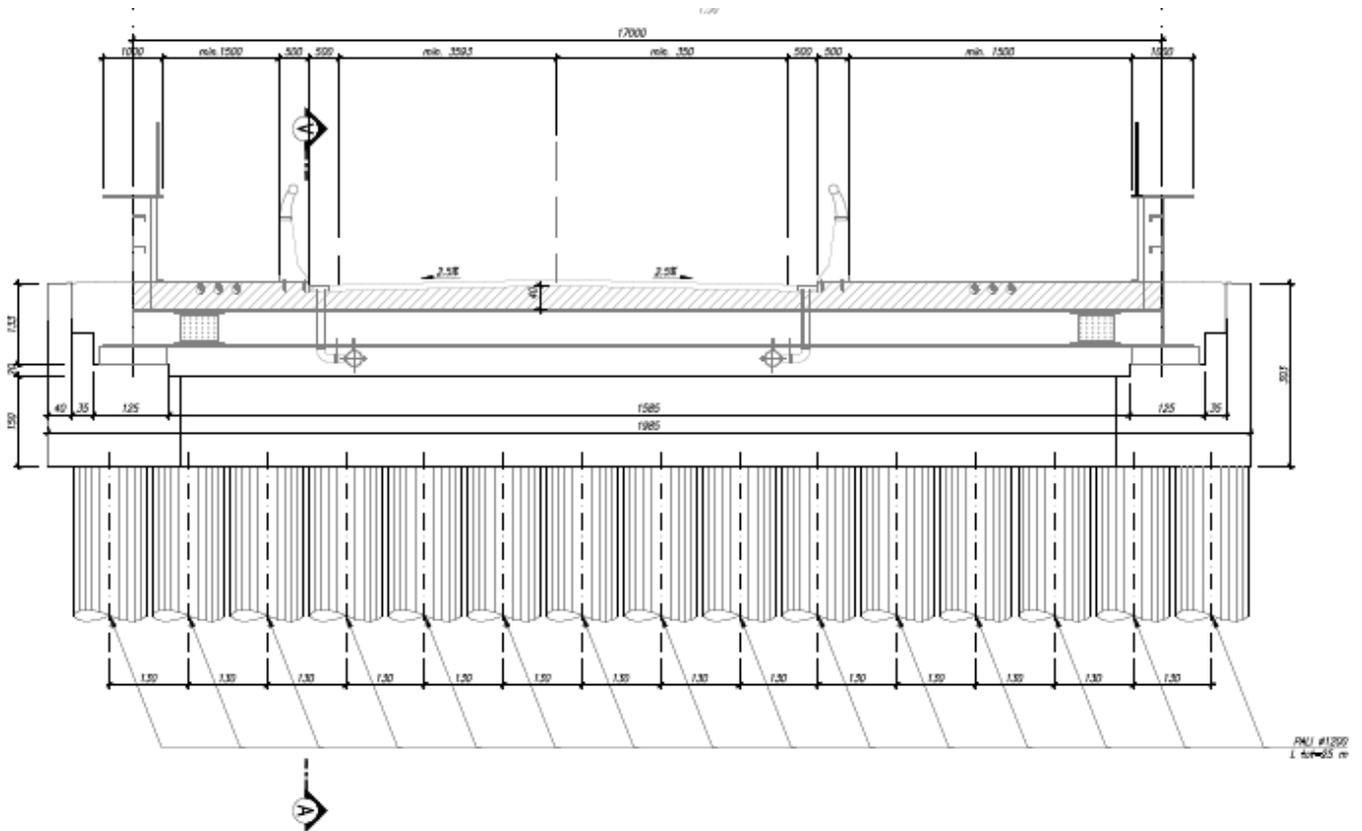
Sezione longitudinale Spalle (Sezione B-B)
